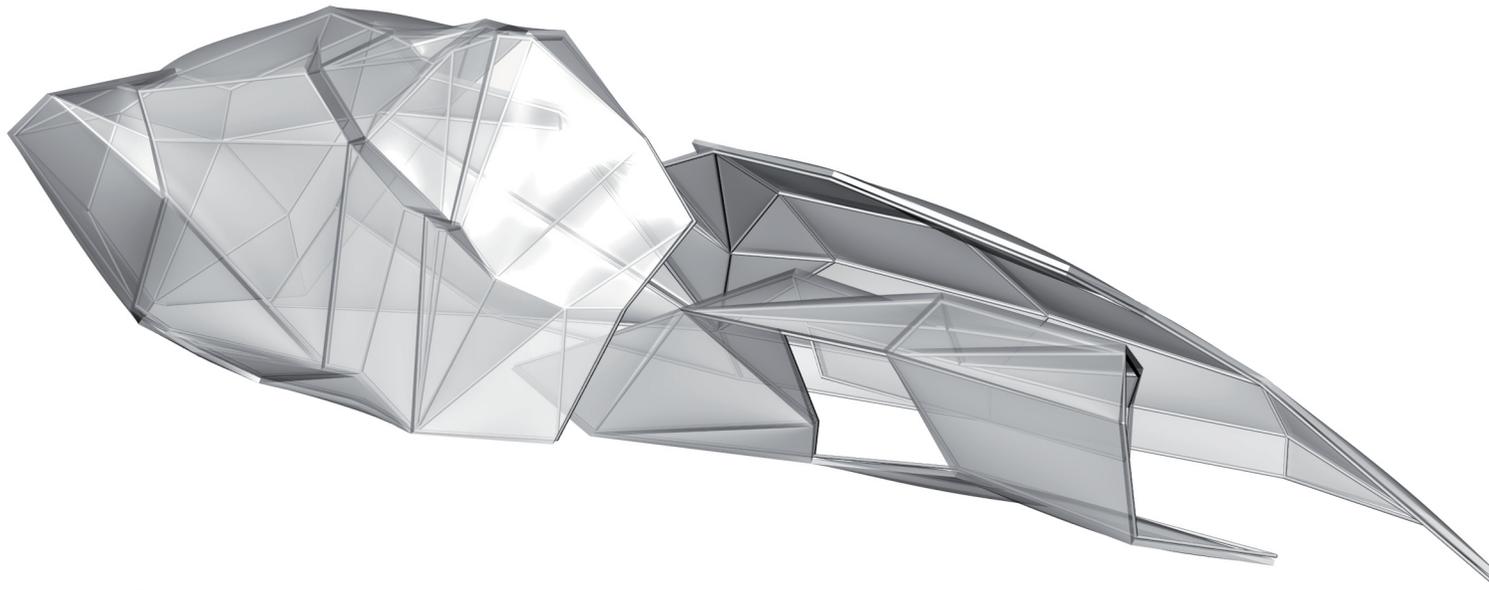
Fassadenlösung durch luftgestützte Kissenkonstruktion
